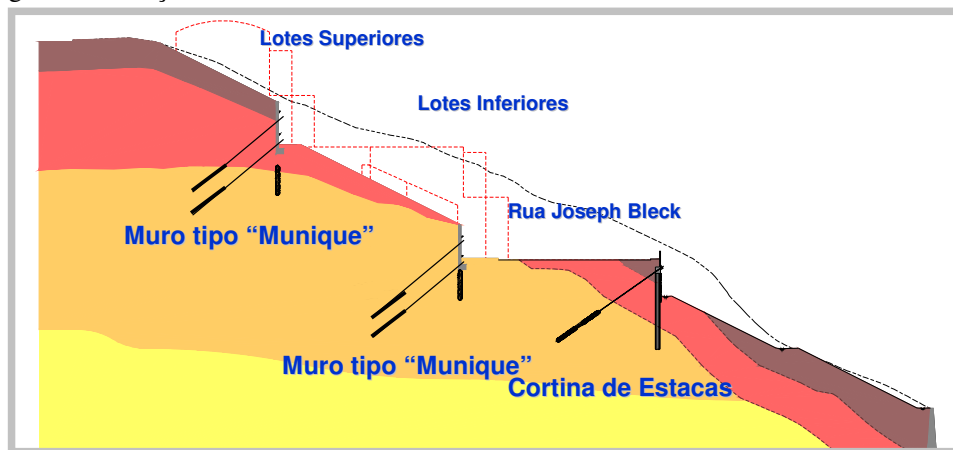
Reperfilamento e implantação dos muros de estabilização da encosta.
